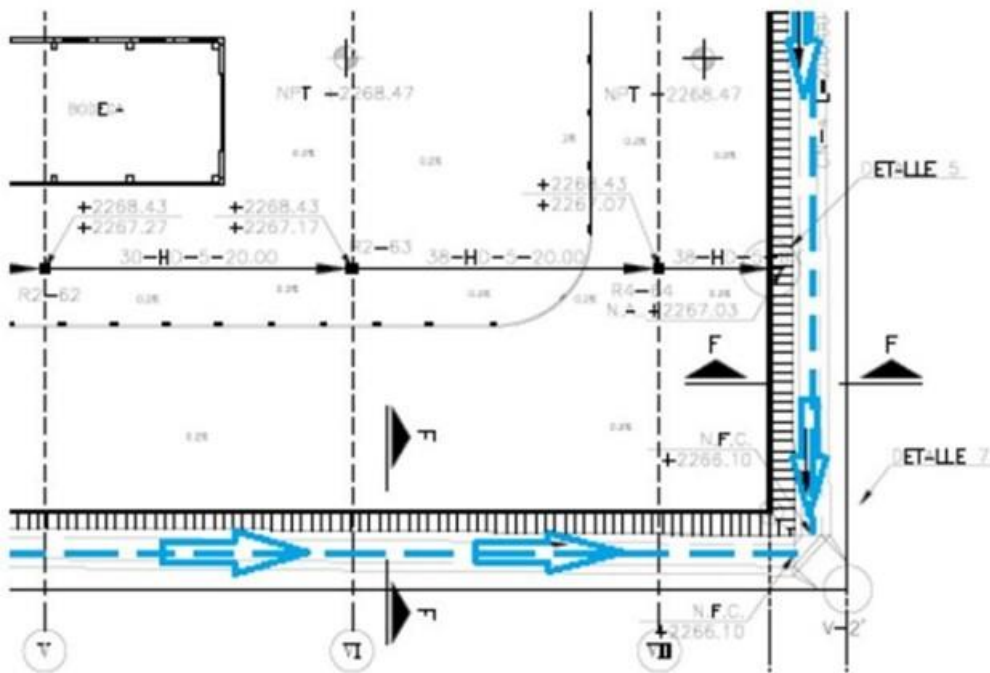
Exemplo de planta que mostra as obras de drenagem da subestação plataforma e detalhe do ponto de descarga
